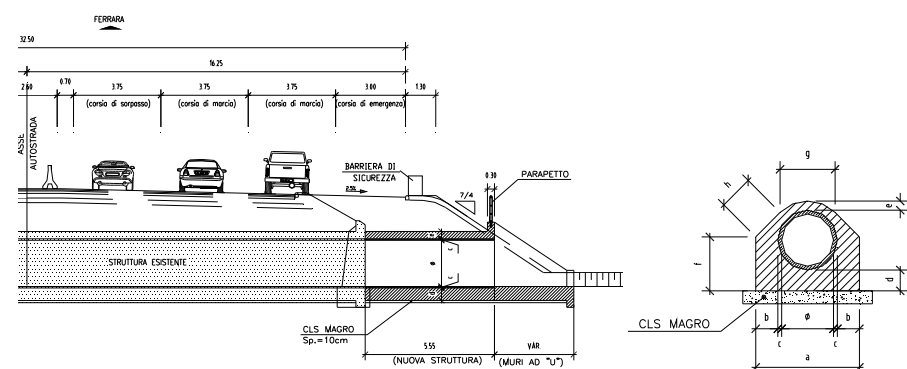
Sezione longitudinale e trasversale tombino tubolare
